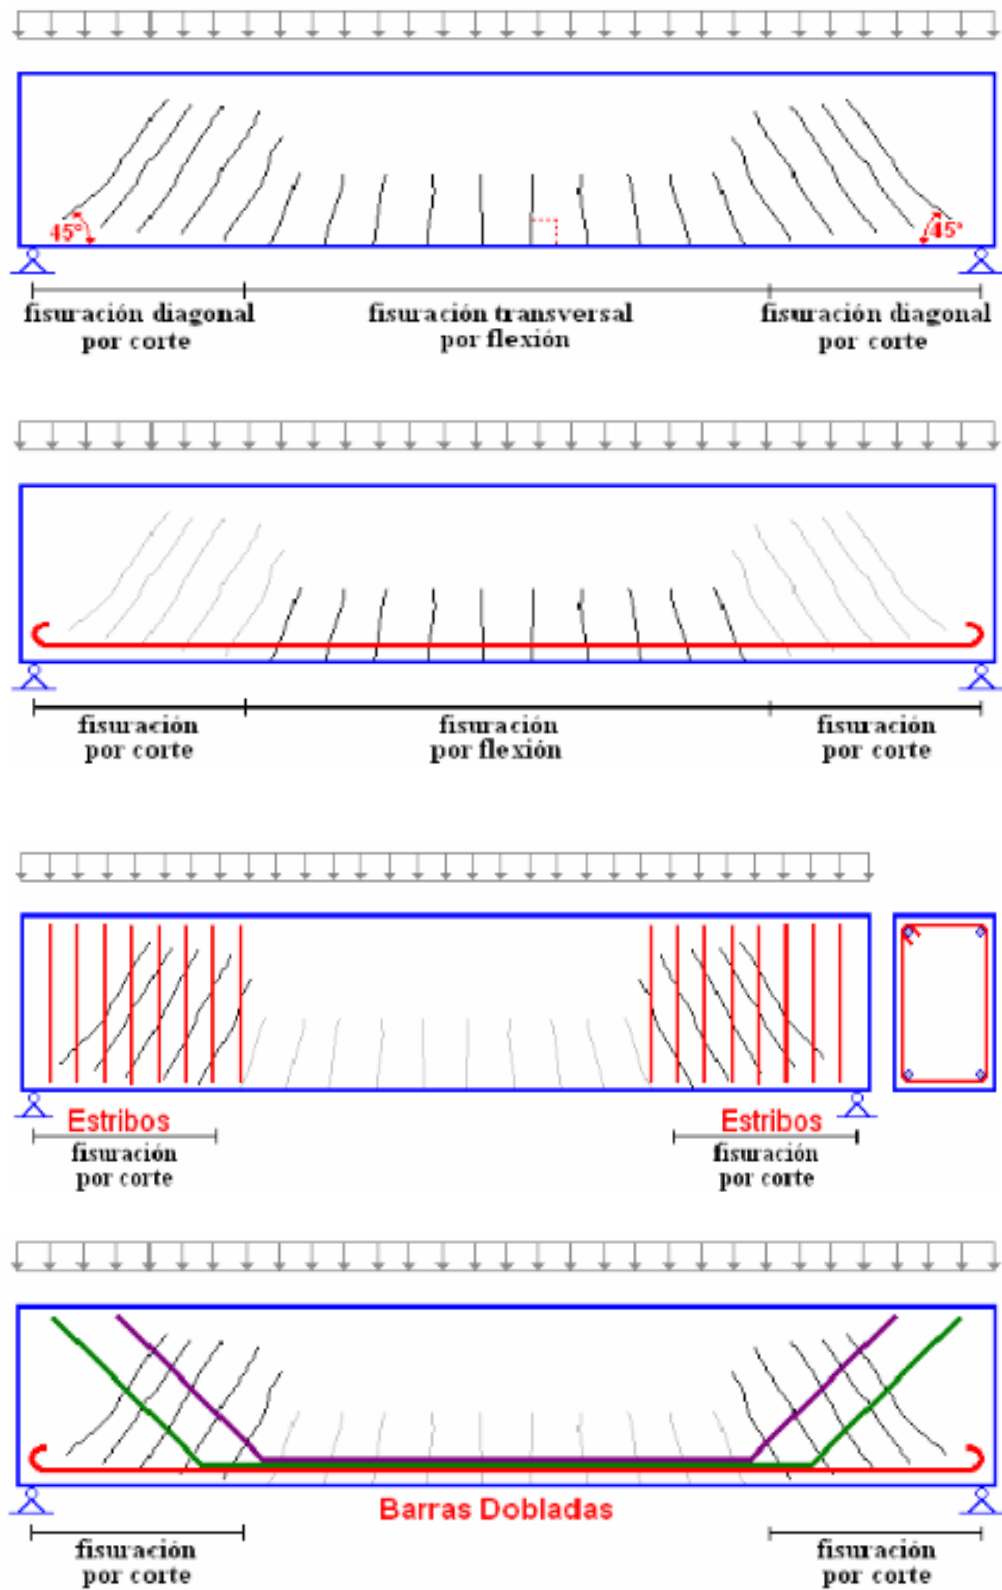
b.1-1) Esquemas de agrietamiento a 45° por tensión diagonal (cortante) y de grietas verticales debidas a flexión, en vigas
